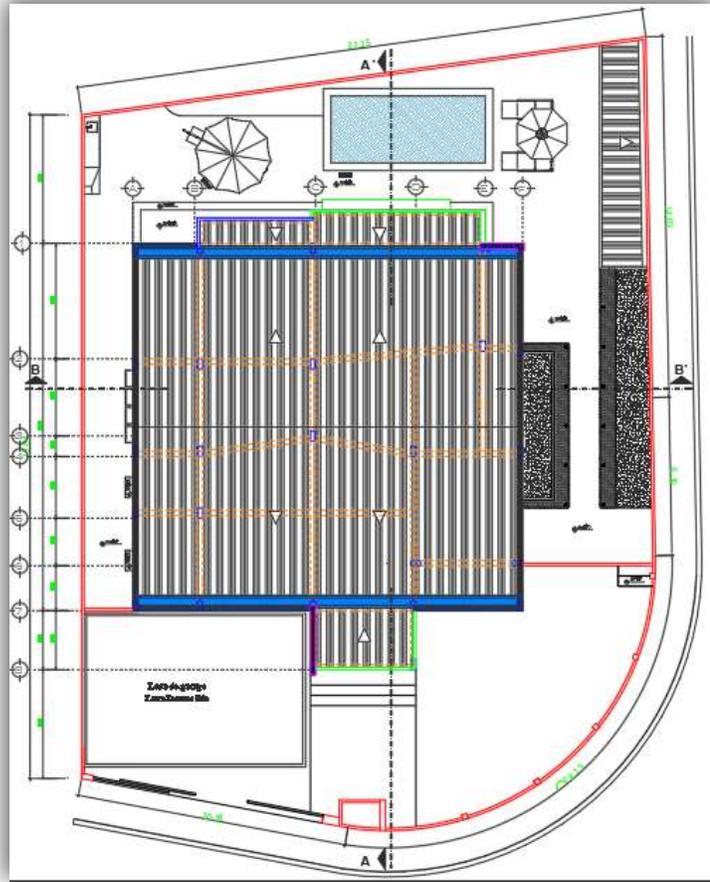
Dimensiones del terreno, Vista en planta Residencia Familiar, Cubierta
